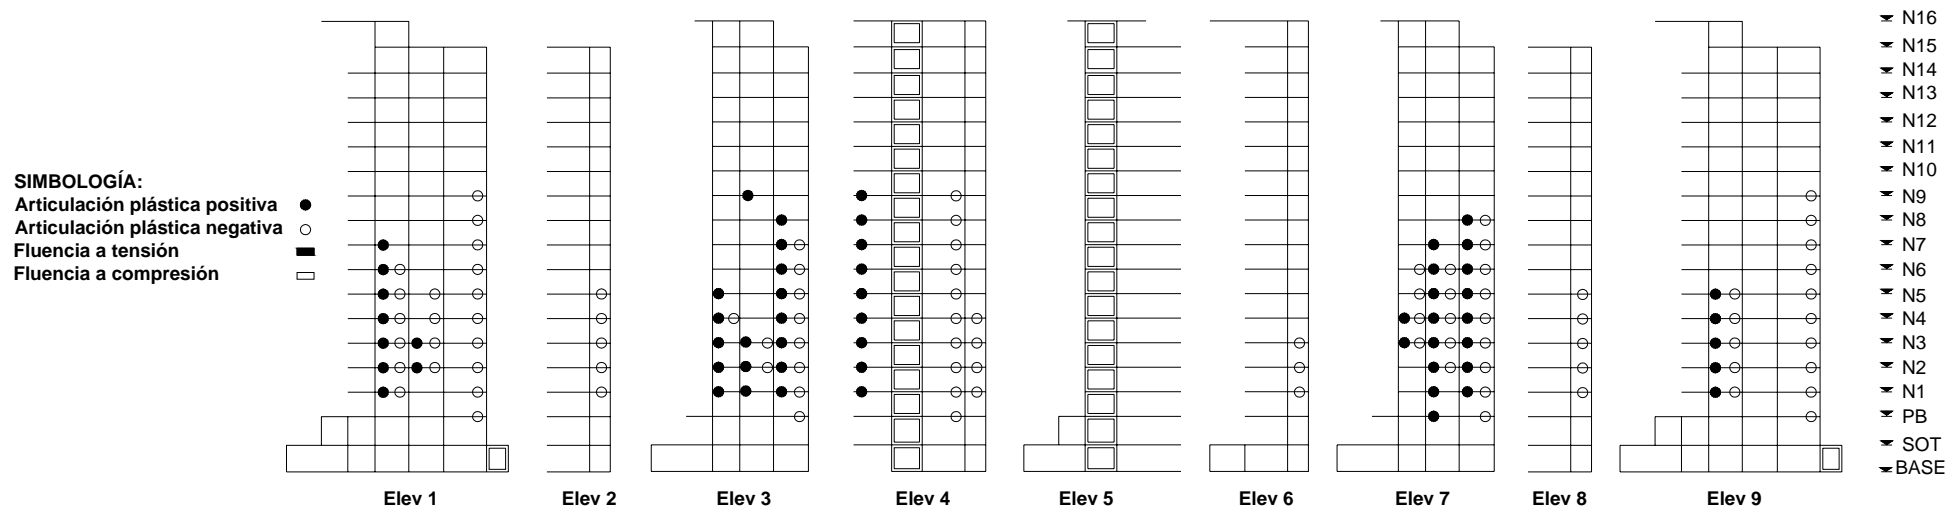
Formación de articulaciones plásticas en vigas y columnas para la SIM81 a los 62.46 s
